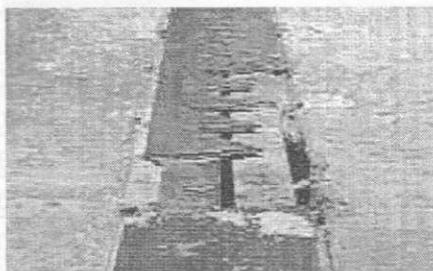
Falla de junta dentada. Puente Dos Ríos (Cauca).
